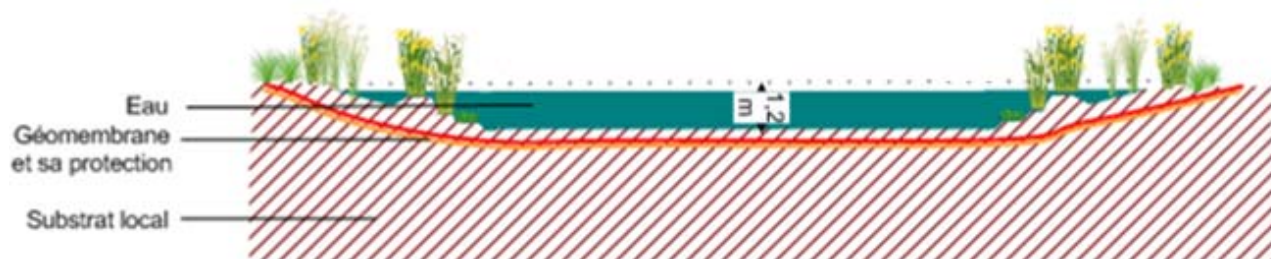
COUPE TRANSVERSALE DES OUVRAGES
